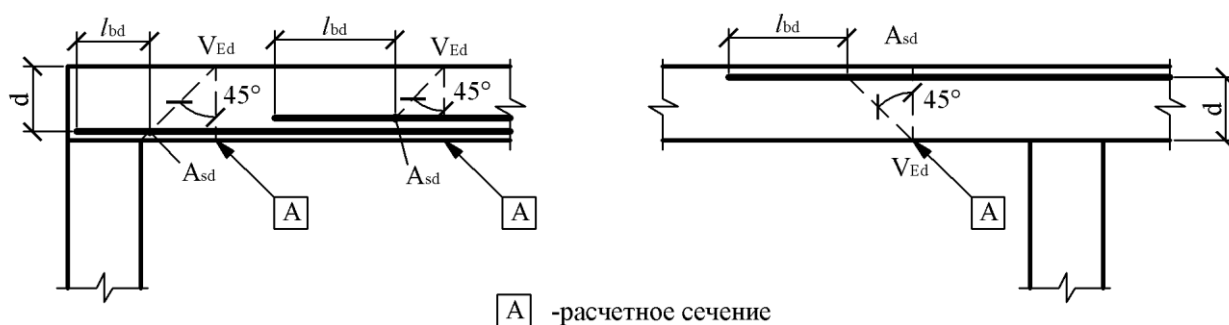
Положение расчётного сечения при определении площади поперечного армирования в формуле (7.116)
